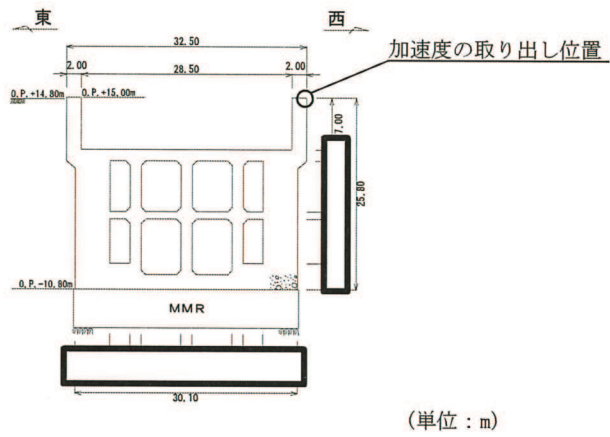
(2) 海水ポンプ室断面図 (スクリーンエリア) (A-A 断面)
